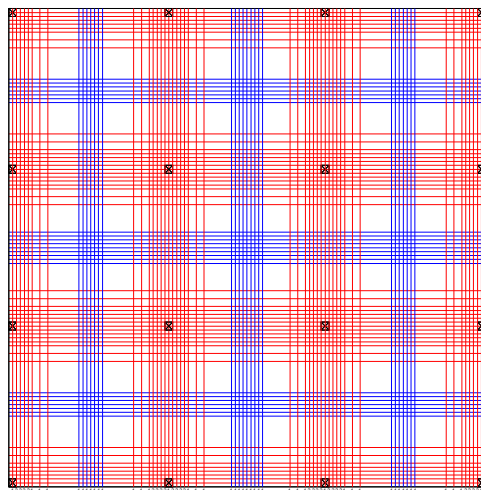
Alternativa de traçado 1 dos cabos no pavimento sem balanço
